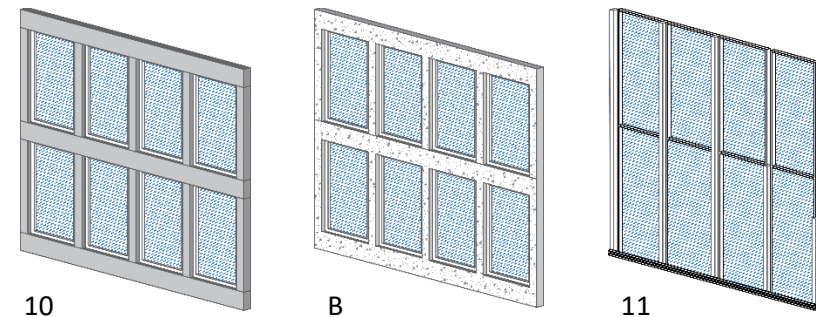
Fachadas autoportantes tipo poste y viga y, muro cortina.
